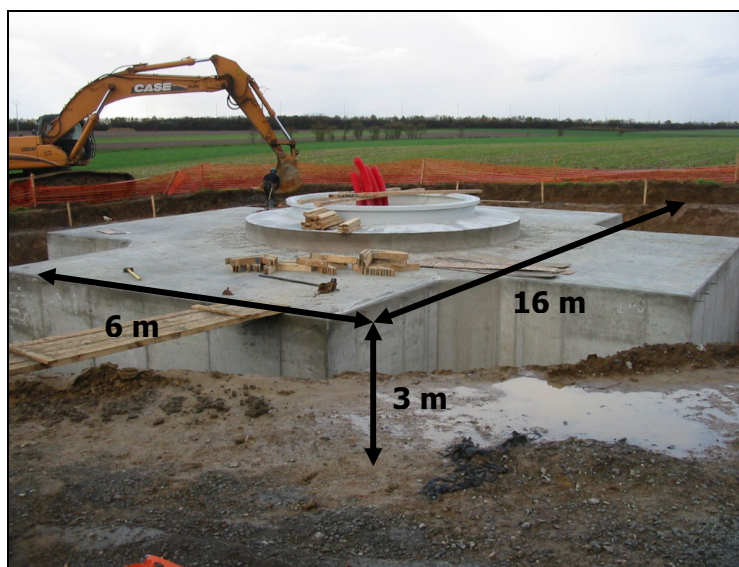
Fondation 'cruciforme' d'une éolienne.
